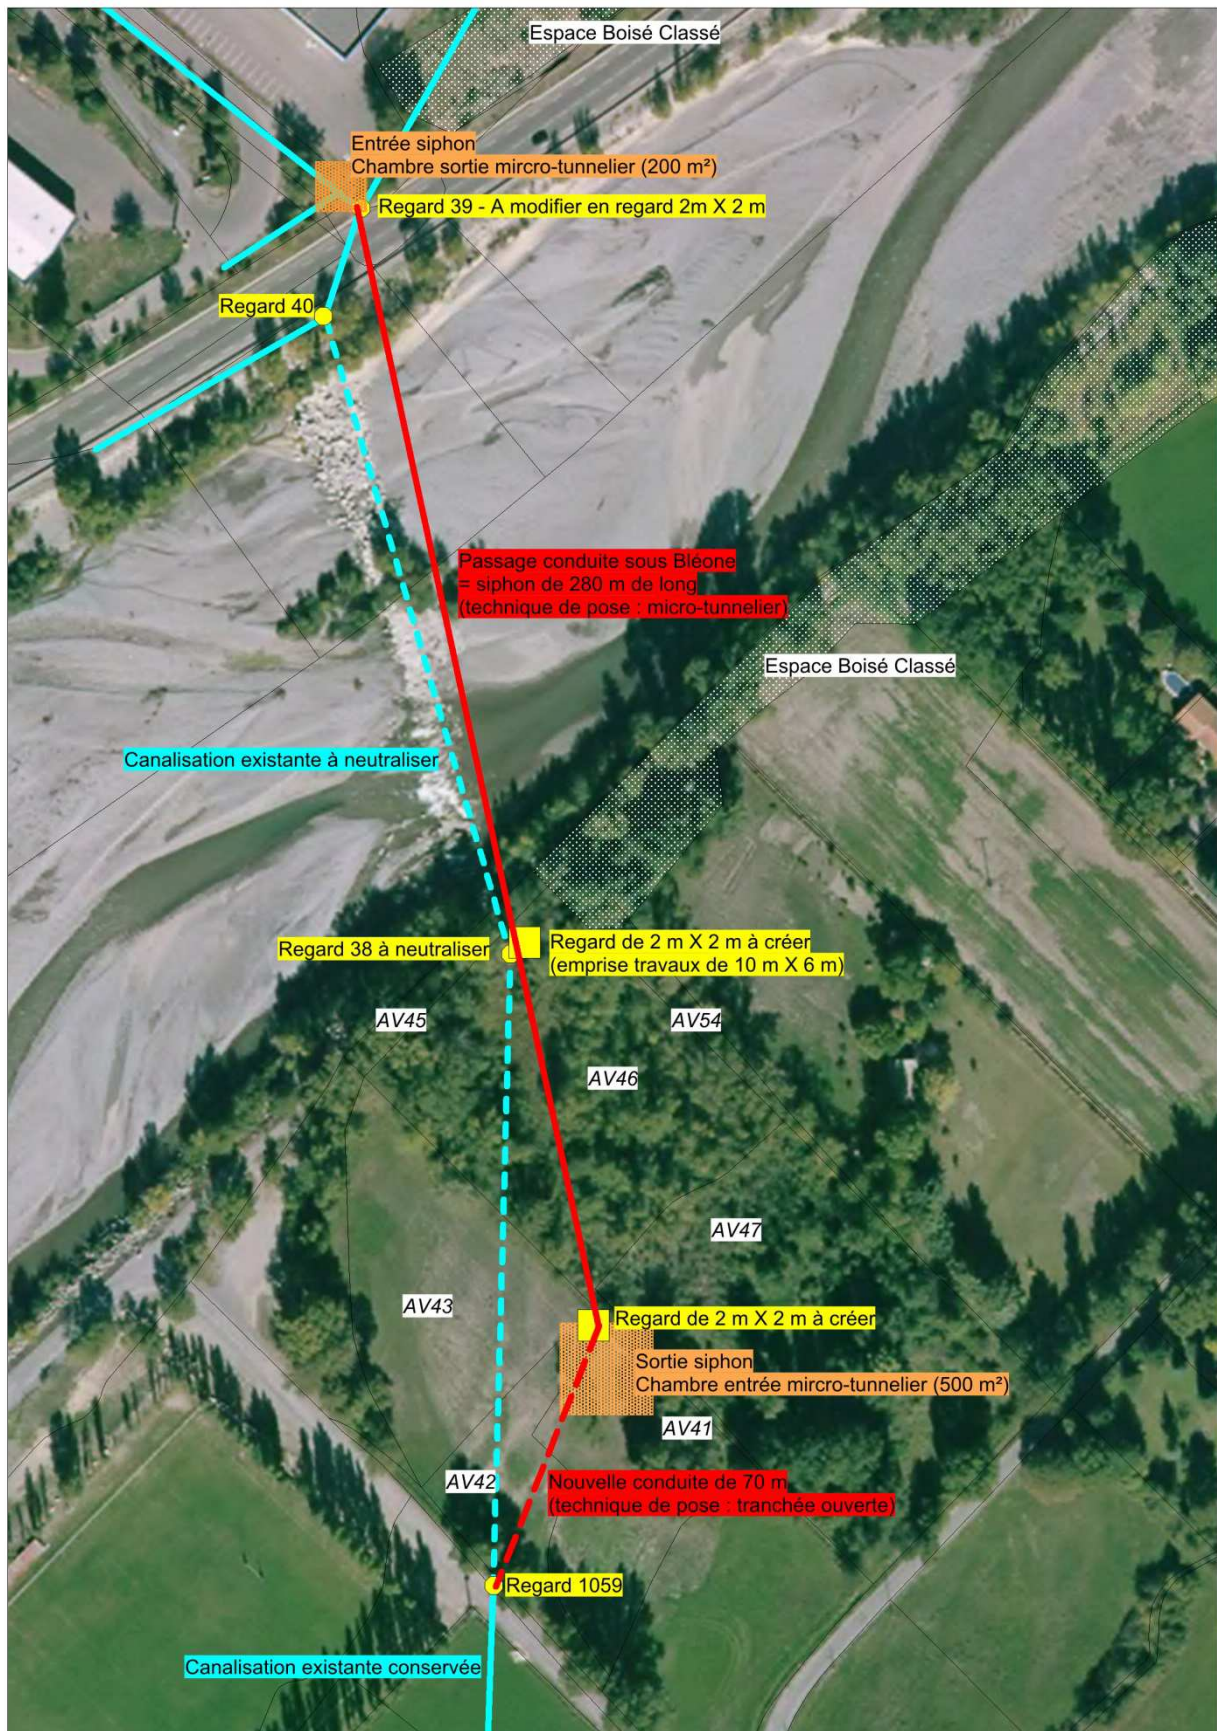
Plan de la modification du tracé de la conduite d'eaux usées
